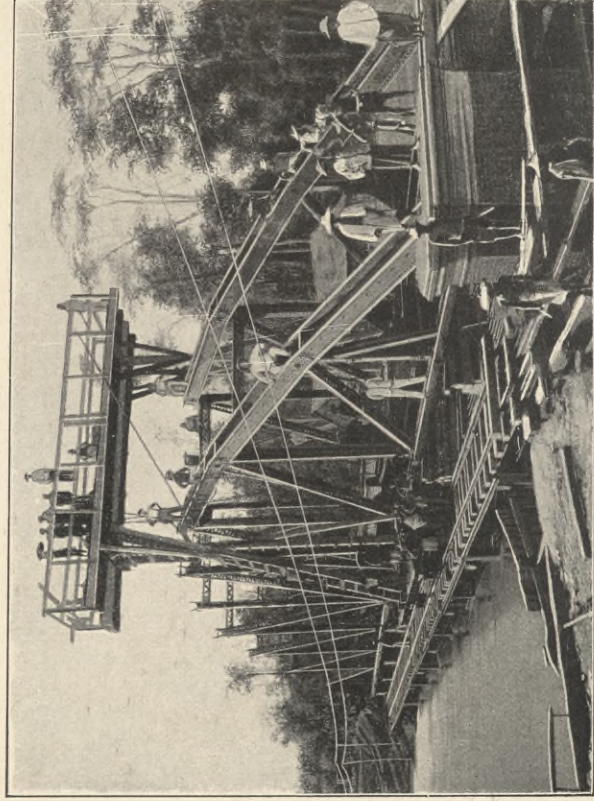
EISENBAHNBRÜCKE ÜBER DEN MINNESUND
